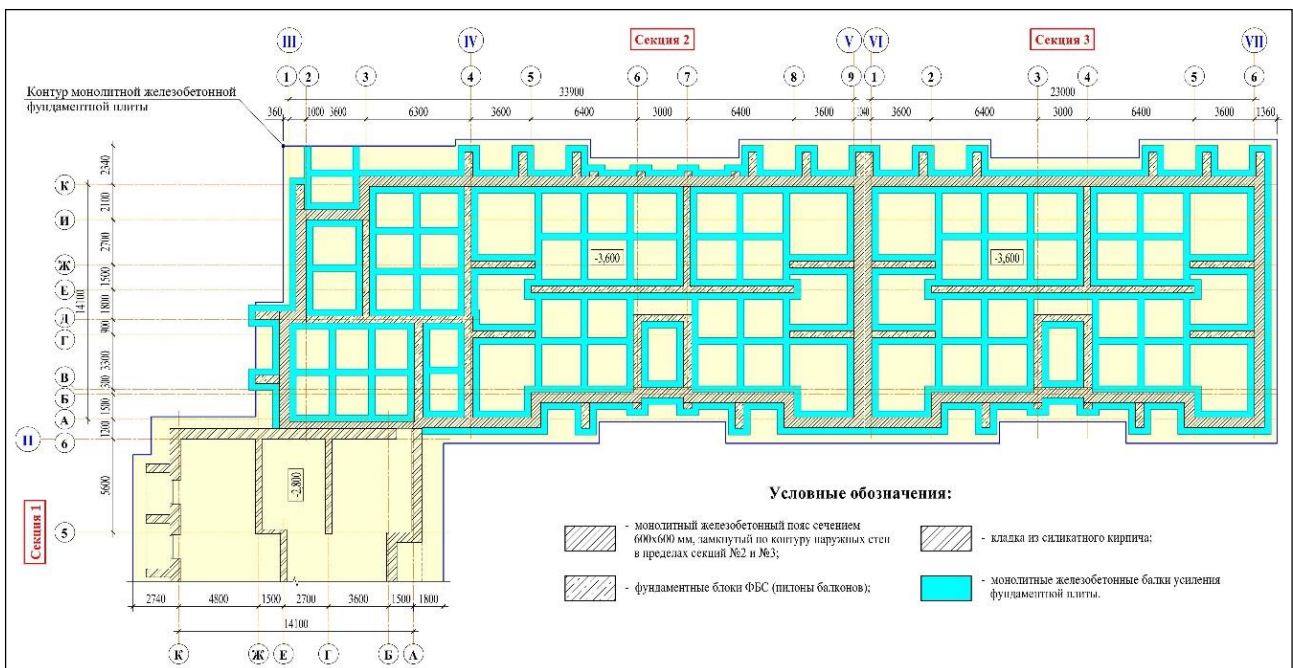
Схема конструктивного усиления фундаментной плиты секций №2 и №3 системой перекрестных монолитных железобетонных балок
